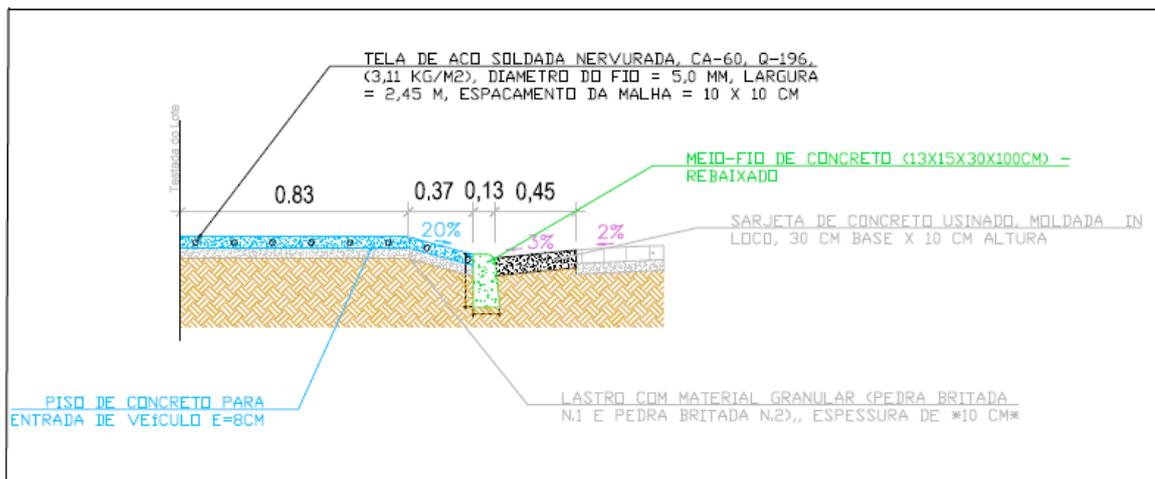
Detalhe construtivo em corte transversal mostrando a armação em aço das rampas de garagem de veículos leves e pesados a executar na Rua Tegino Vargas e dos trechos adjacentes de calçada
